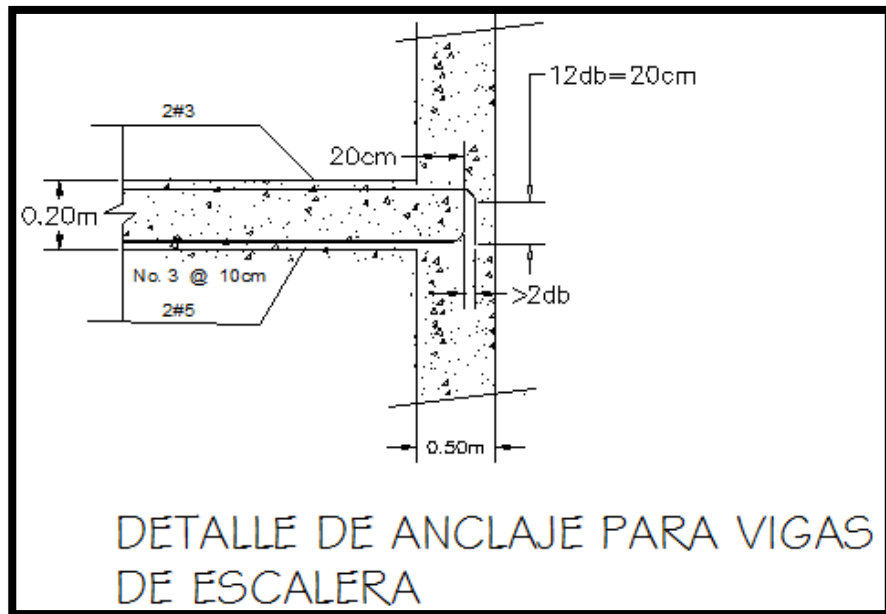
Longitud de anclaje para vigas de escaleras.
